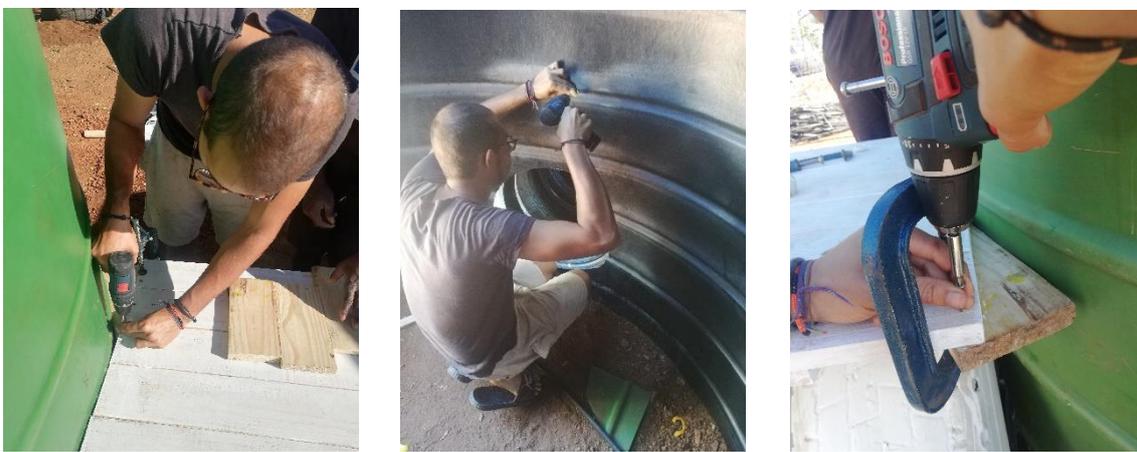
Instalación de la mesa del mercado. Fuente: Propia
